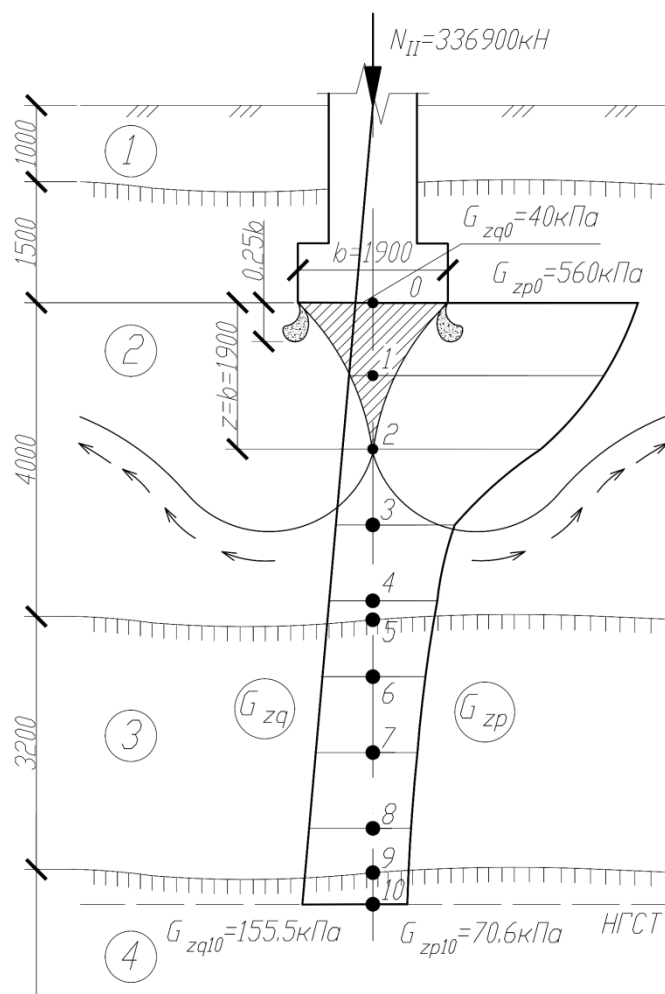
К расчету осадки фундамента с учетом нелинейности
